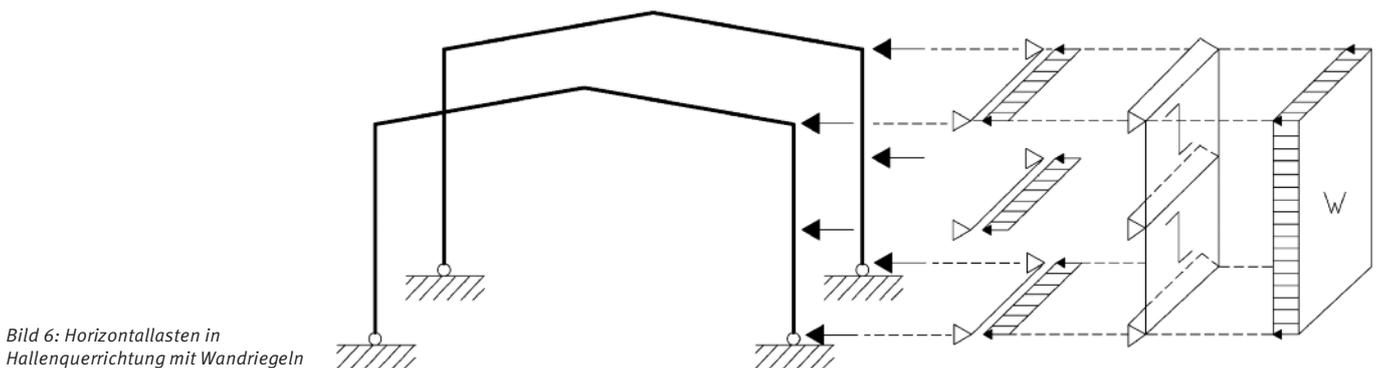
Horizontallasten in Hallenquerrichtung mit Wandriegeln
